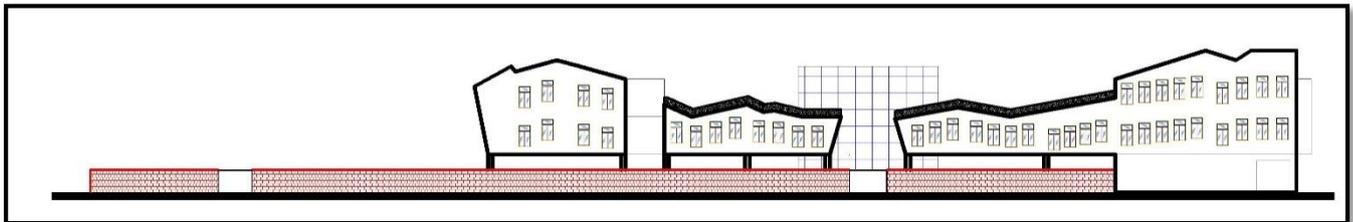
Adaptation des ouvertures sur de la façade EST Source : Auteurs
